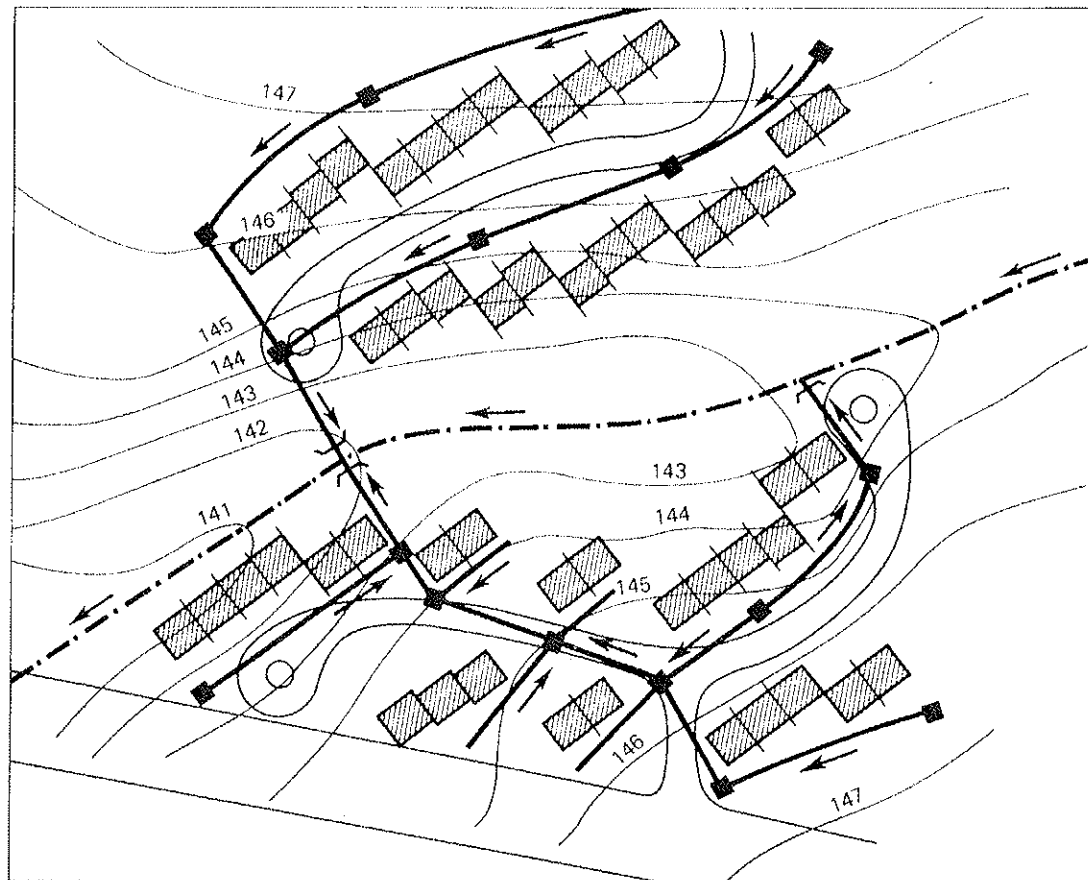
Exemple de drainage collectif d'un lotissement sur un terrain en pente
